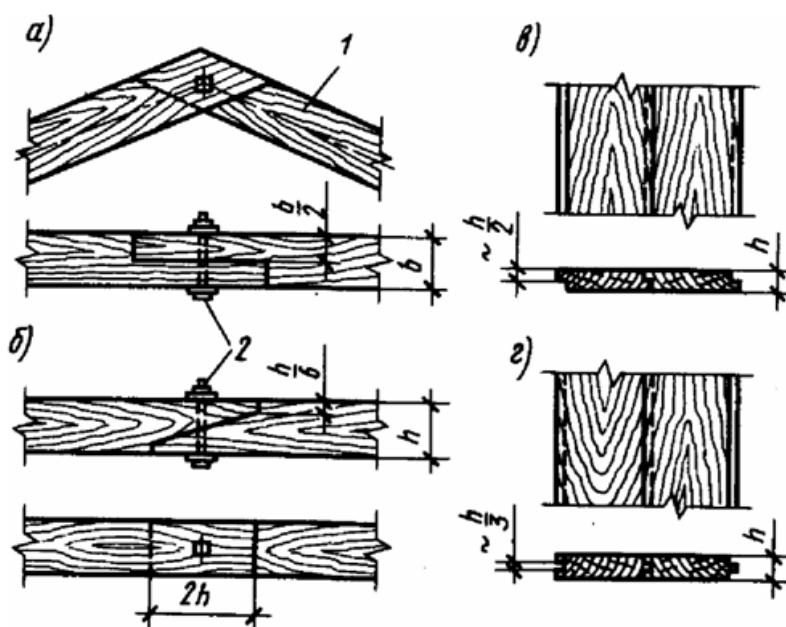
Конструктивні рубки: а — рубка в півдерева; б — косий прируб; в — з'єднання у чверть; г — з'єднання в шпунт
